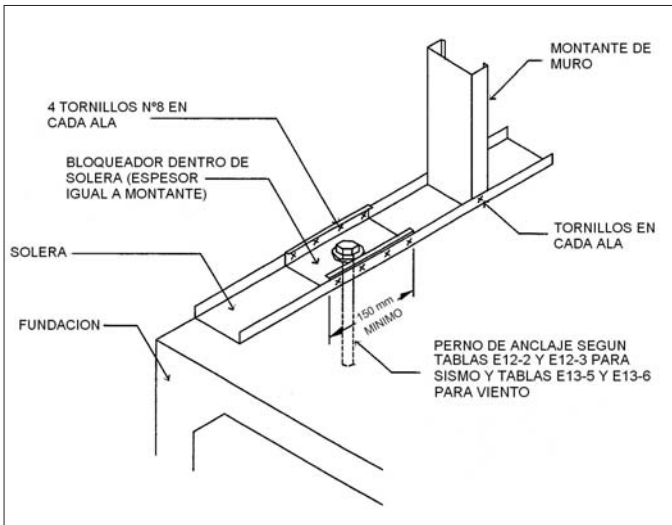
Conexión de Muro Arriostrado con Fundación
